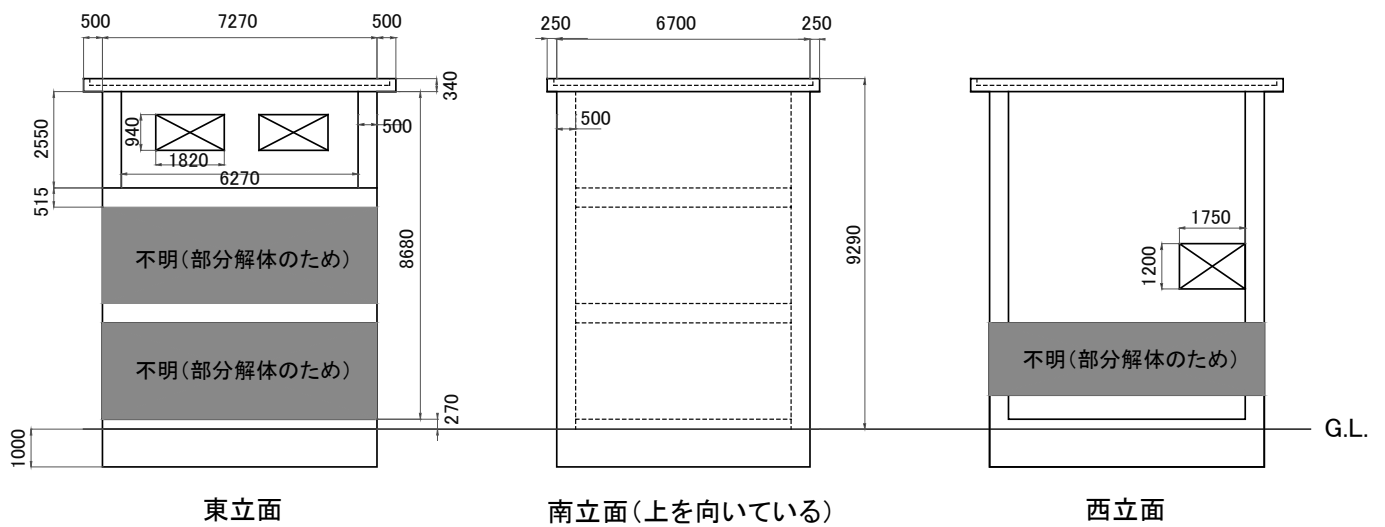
RC 造 3 階建て住宅の立面図（単位：mm）
